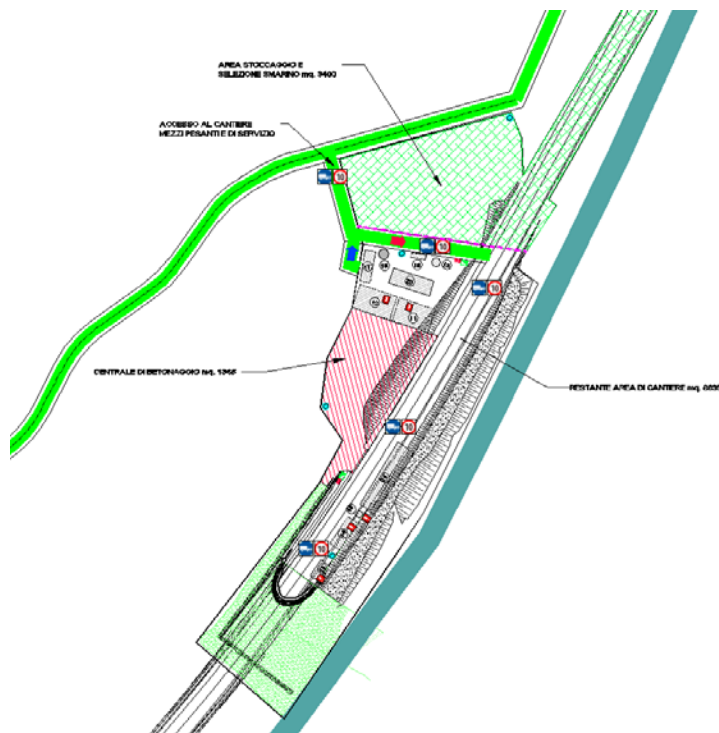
Planimetria cantiere operativo "Casacastalda".
